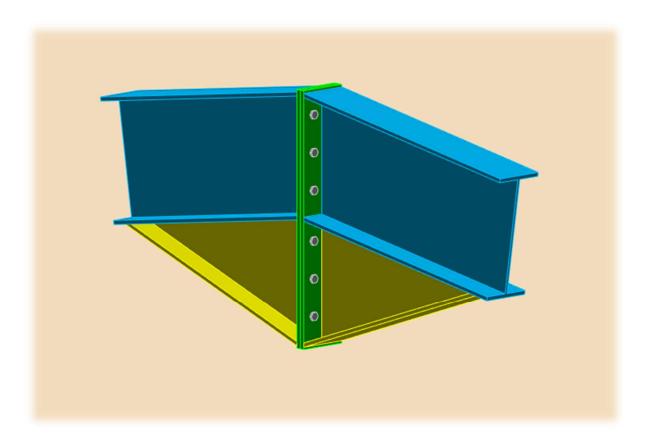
3D d'assemblage poteau - traverse (IPE500-IPE500)
